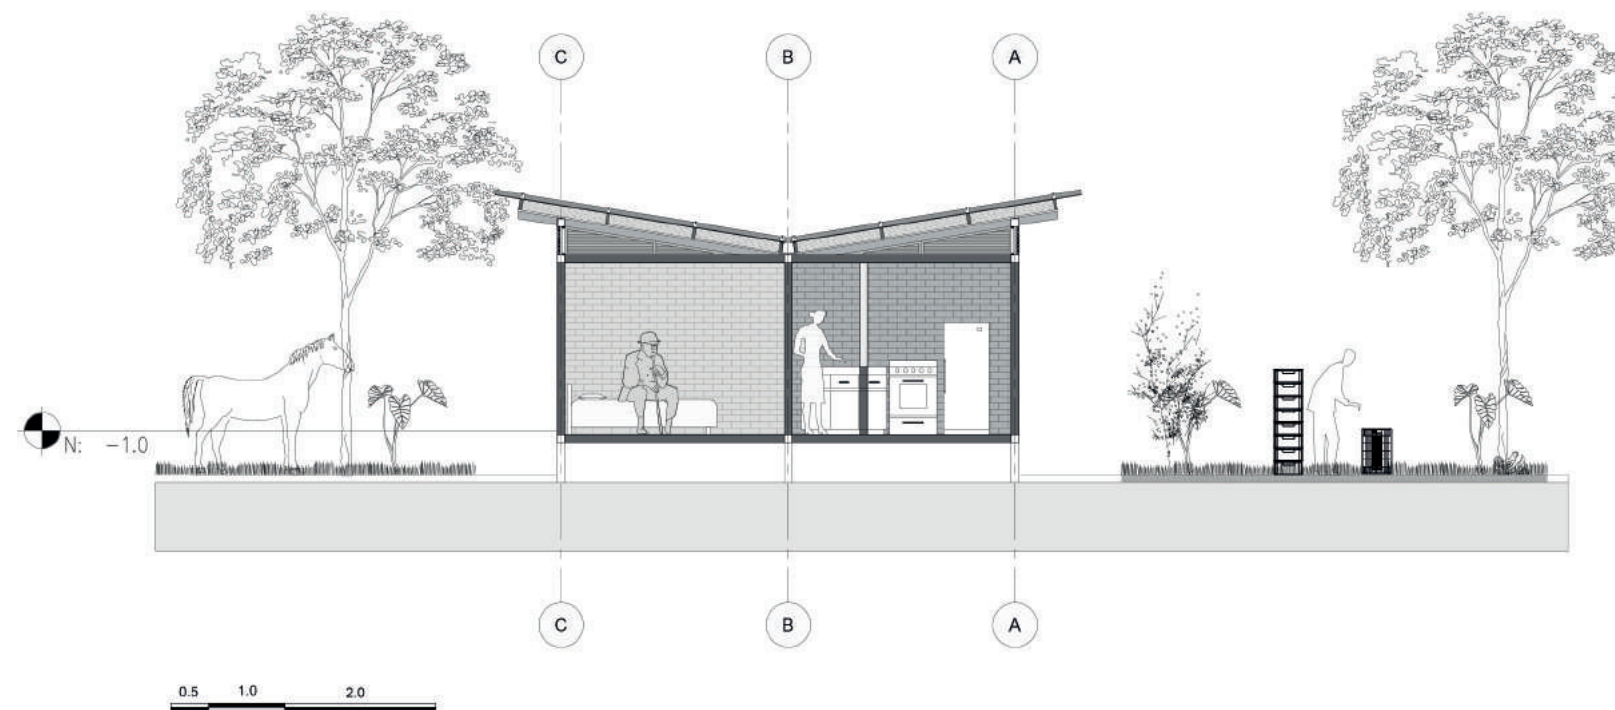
, Sección arquitectónica C-C' borde de río, Julián López, Juan Diego López, 2020.
